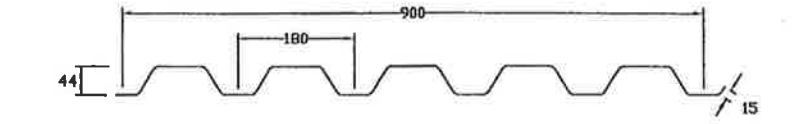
PLATEAUX HORIZONTAUX HACIERBA AUTORISES
